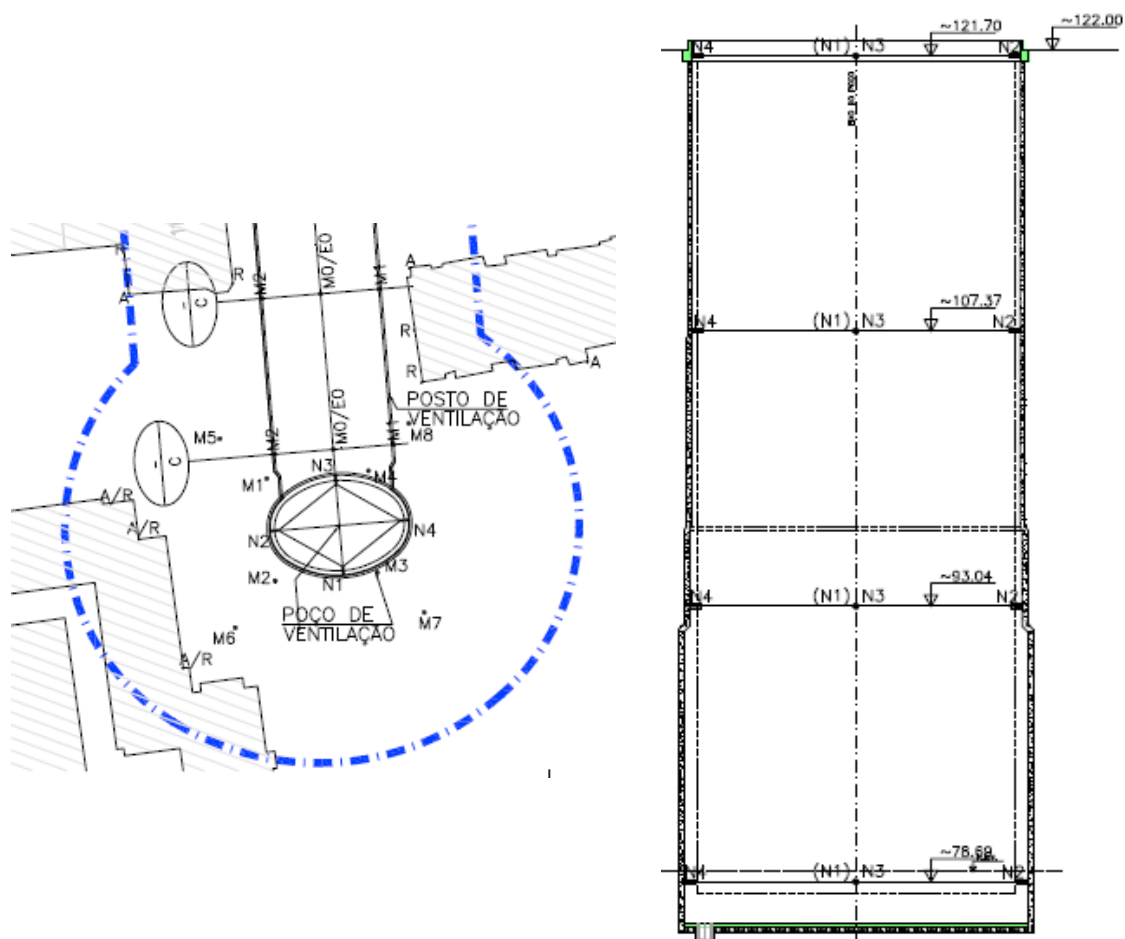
Instrumentação do Poço de Ventilação – Planta e perfil.
